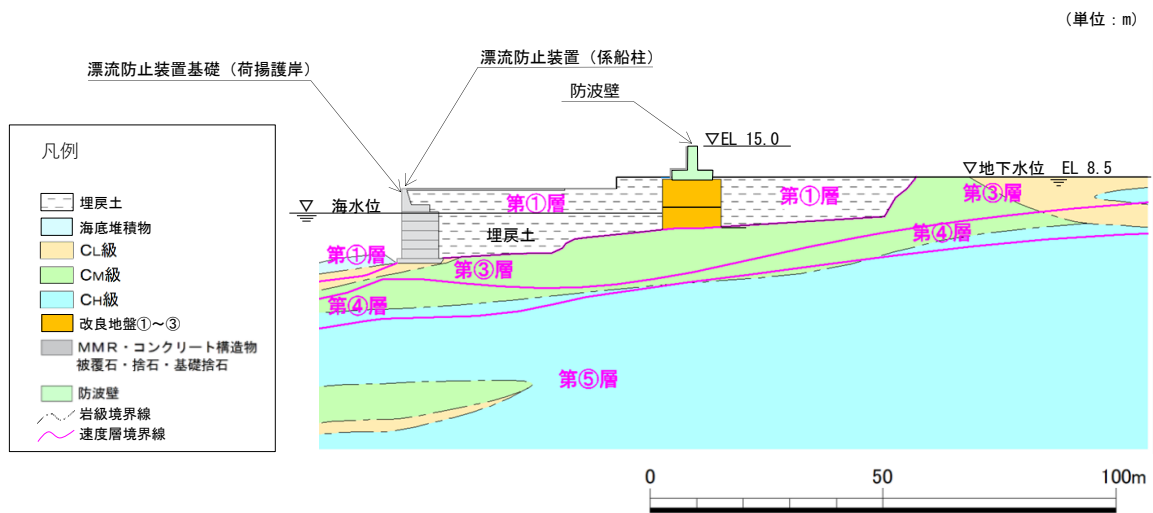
地質断面図 (⑥-⑥断面)
